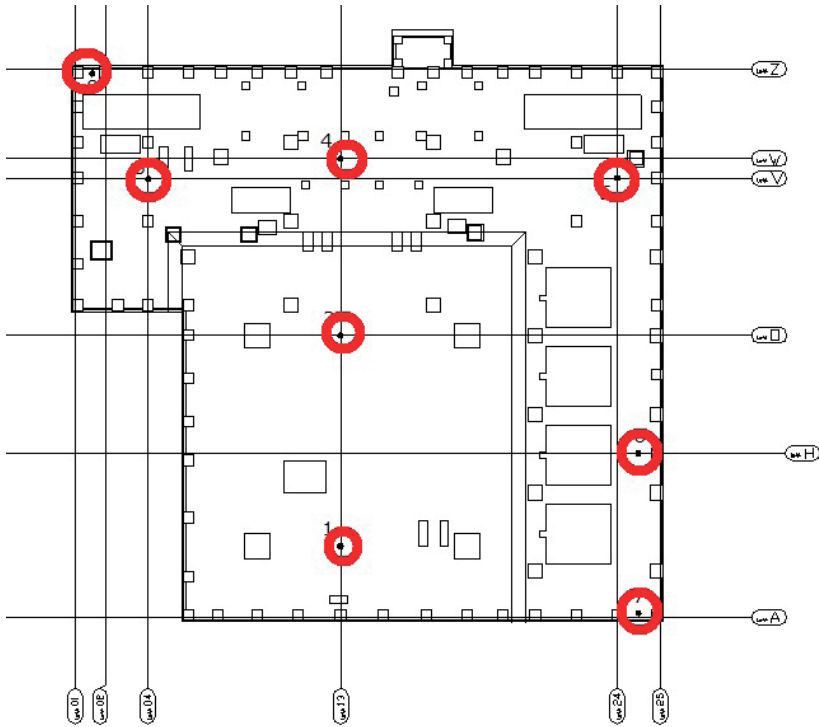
Plan betonowania i rozmieszczenia pomp – etap II
